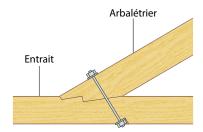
Exemple d'assemblage entrait – arbalétrier par un boulon
